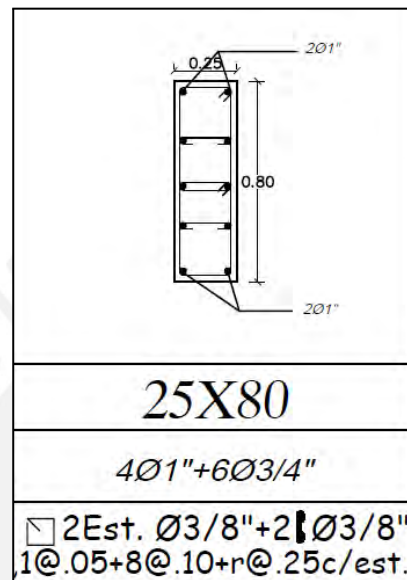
Detalle de la columna C-04 para sus primeros niveles.(Fuente:propia)
